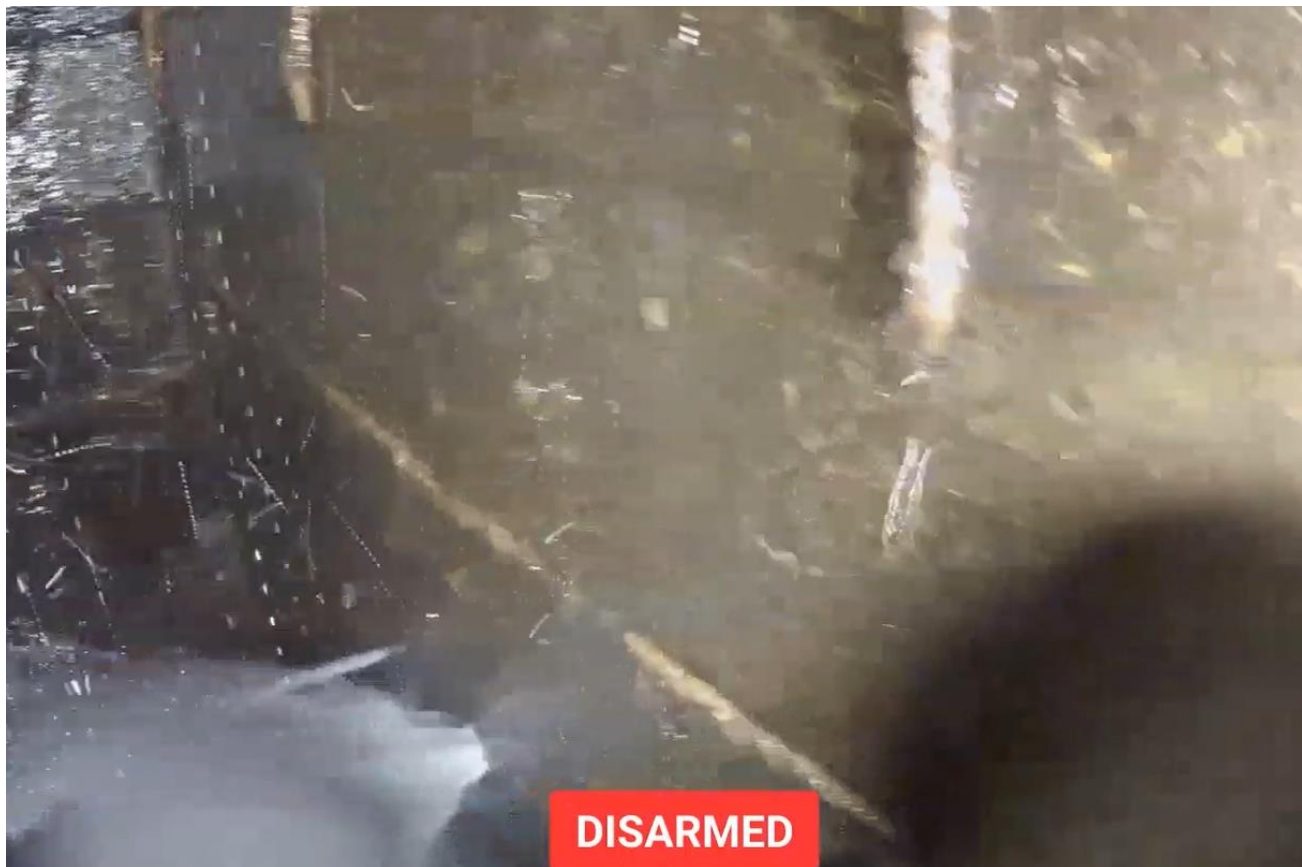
Detailní pohled na průsak v hloubce cca 6 m na západní stěně štoly.
